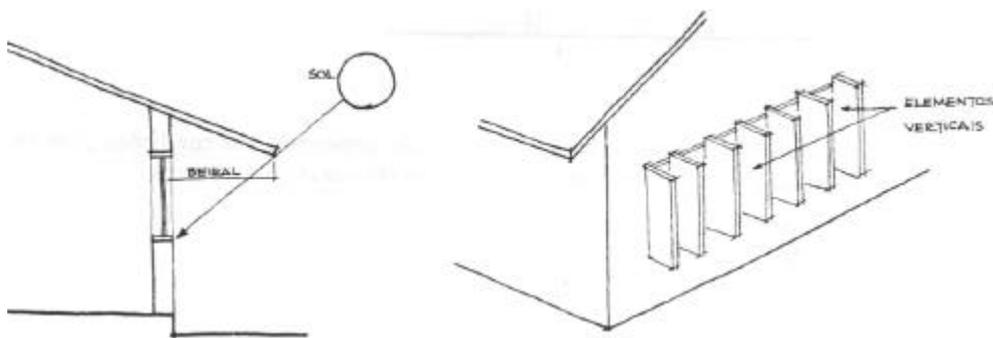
Croqui do Manual da CARPE - elementos de proteção à insolação. Fonte : CARPE (1983)
